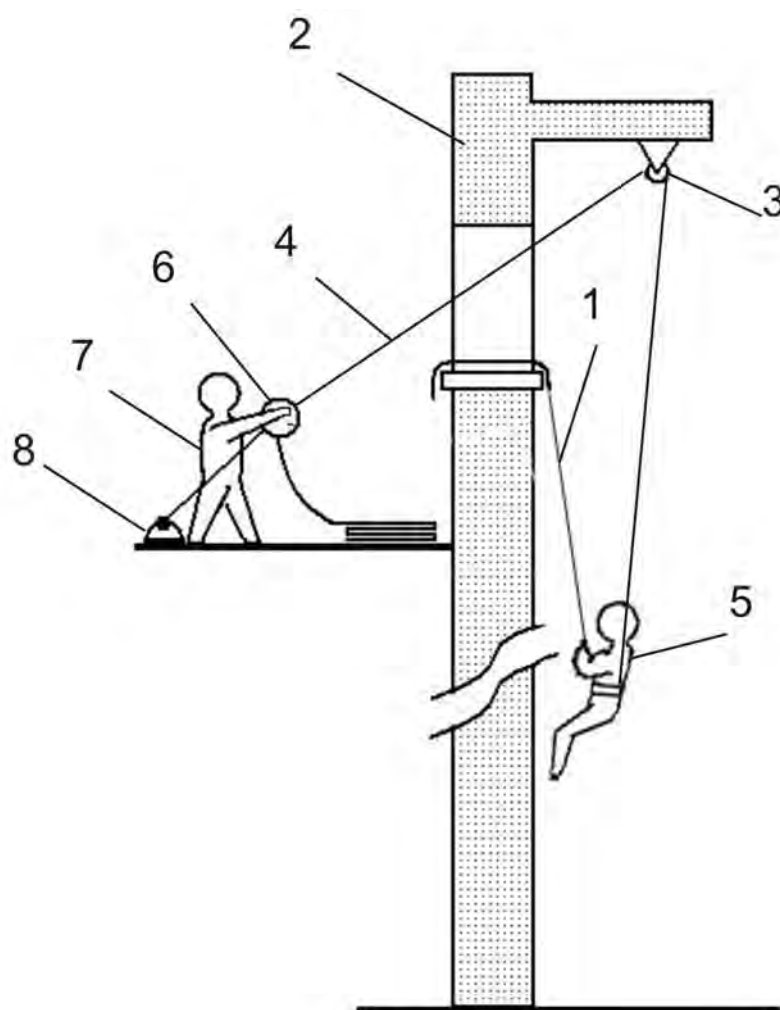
Схема обеспечения верхней страховки с точкой крепления
